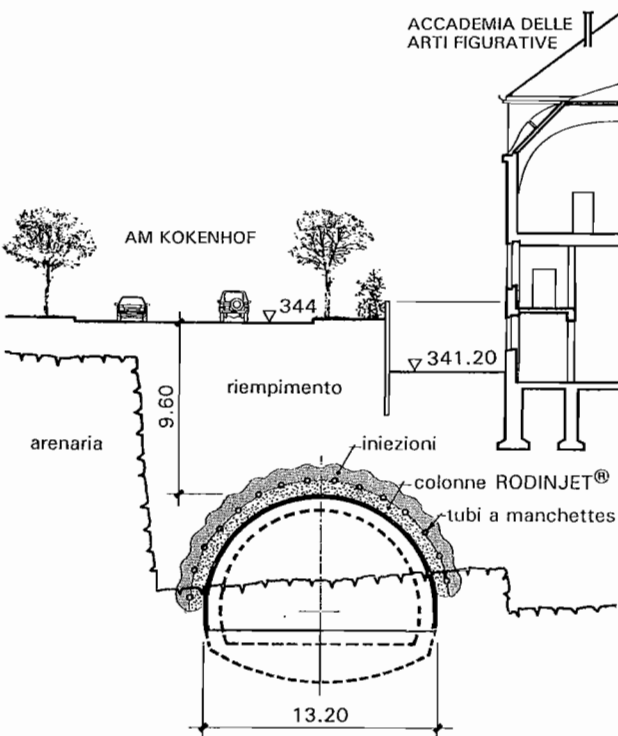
Galleria di Killesberg - Sezione trasversale.
